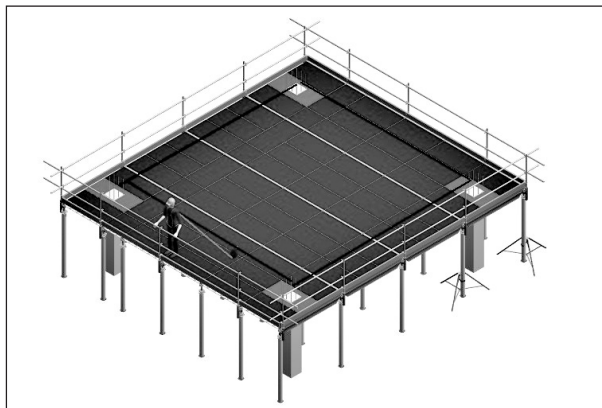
Colocación de pies de barandilla, tubos de las barandillas superior e intermedia y rodapiés
